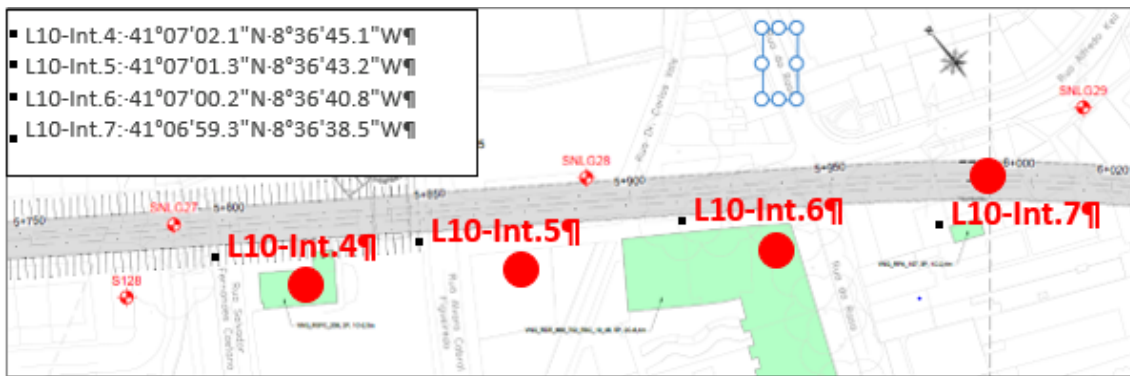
Pontos de monitorização (km 5+750 a km 6+020; vibrações – construção)
